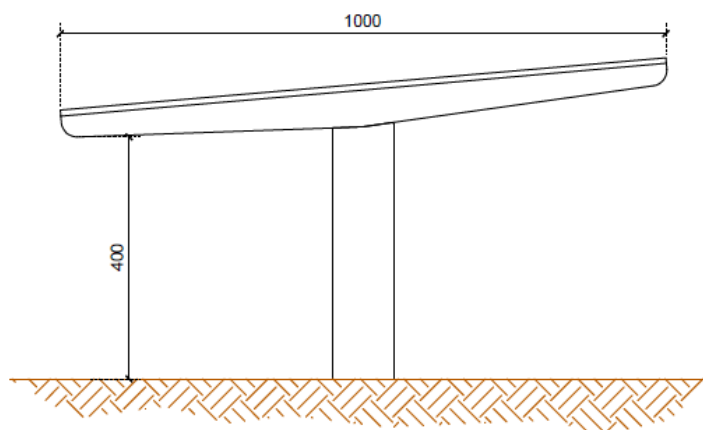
Dettaglio sezione copertura estrapolato dall’elaborato grafico di progetto
